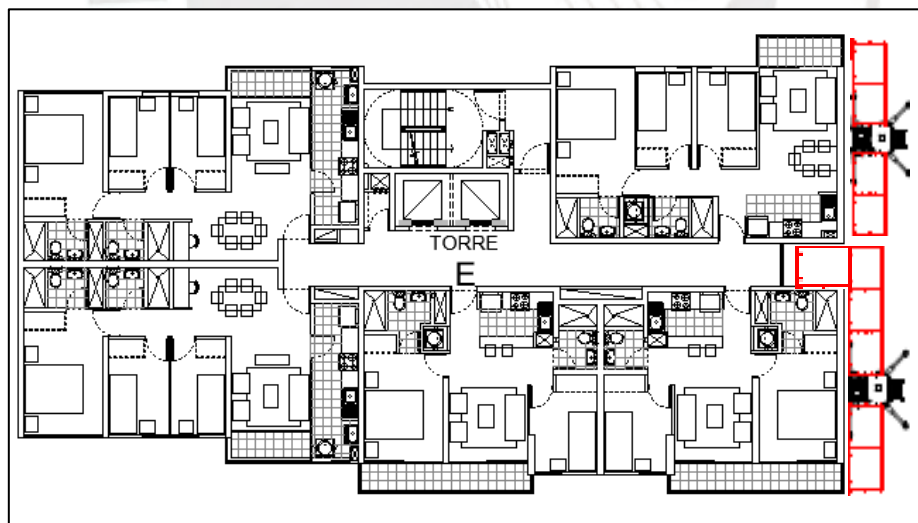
Esquema posición monomástil fachada muro ciego
